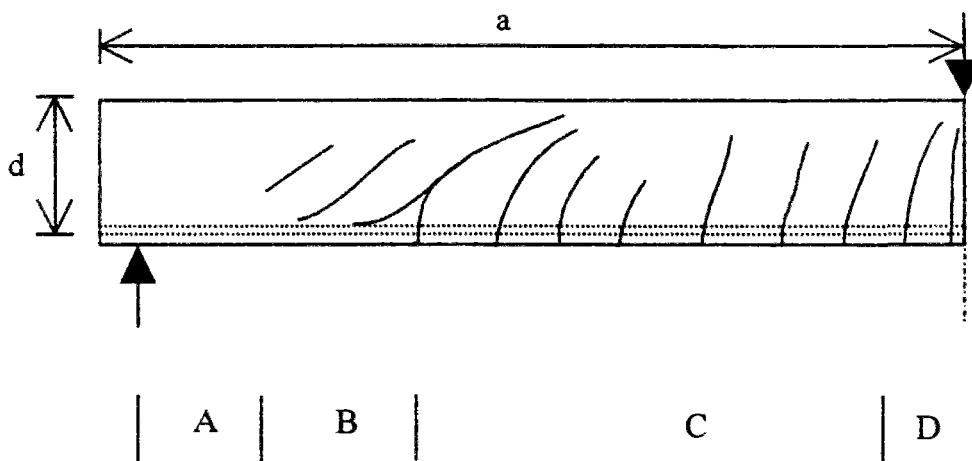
Zones de fissuration d'une poutre en flexion (d'après [Leonhardt 1971]).
